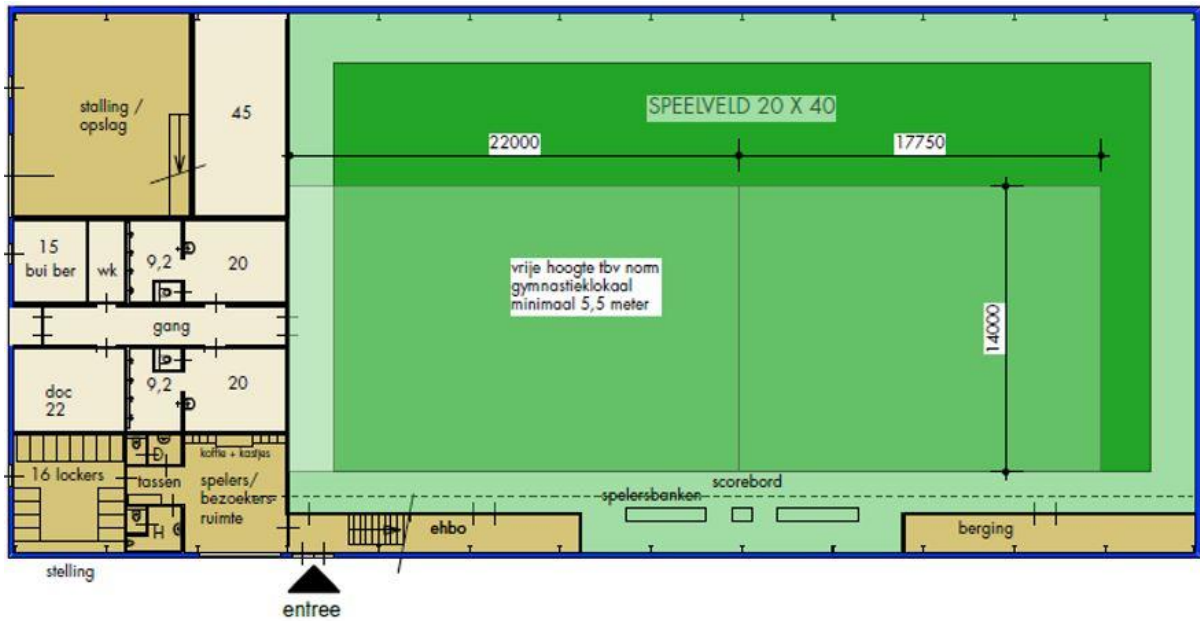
Gewenste ontwikkeling plangebied (bron: Architectenbureau John Velthuis)
